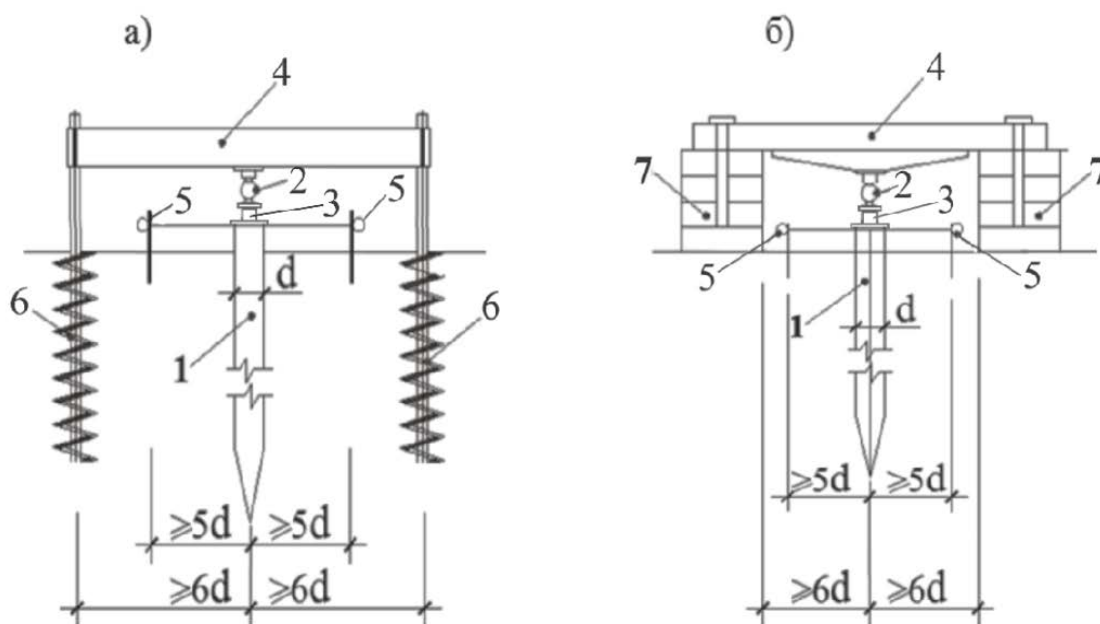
Схемы установок для испытания натуральных НРСн статической вдавливающей нагрузкой: 1- НРСн; 2- образцовый динамометр; 3- гидравлический домкрат; 4- упорная балка; 5- прогибомер; 6- винтовые анкеры; 7- пригрузы платформы.
